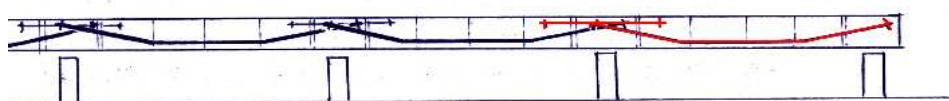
Esquematização do traçado de pré-esforço aplicado na construção tramo a tramo.
